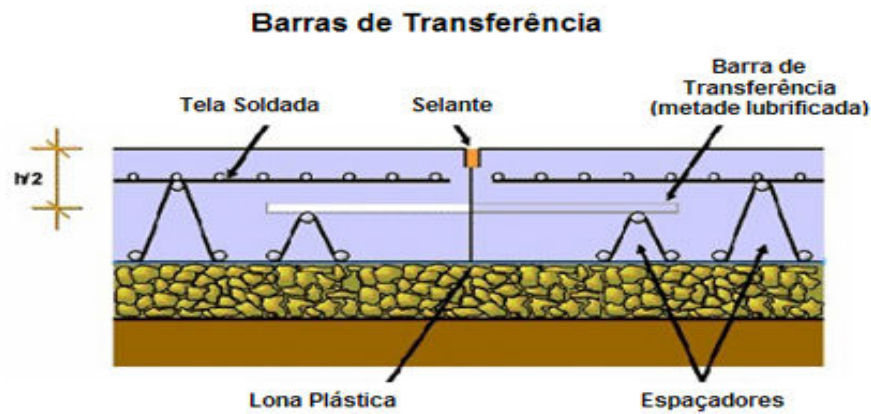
Detalhe da barra de transferência posicionado sobre treliça.
